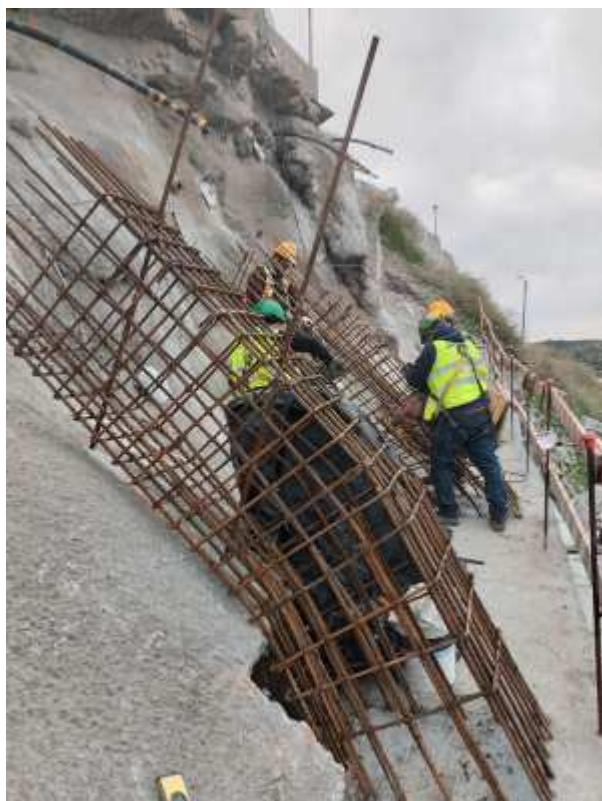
Montagem de Armaduras dos Montantes Verticais 1ª Fase
